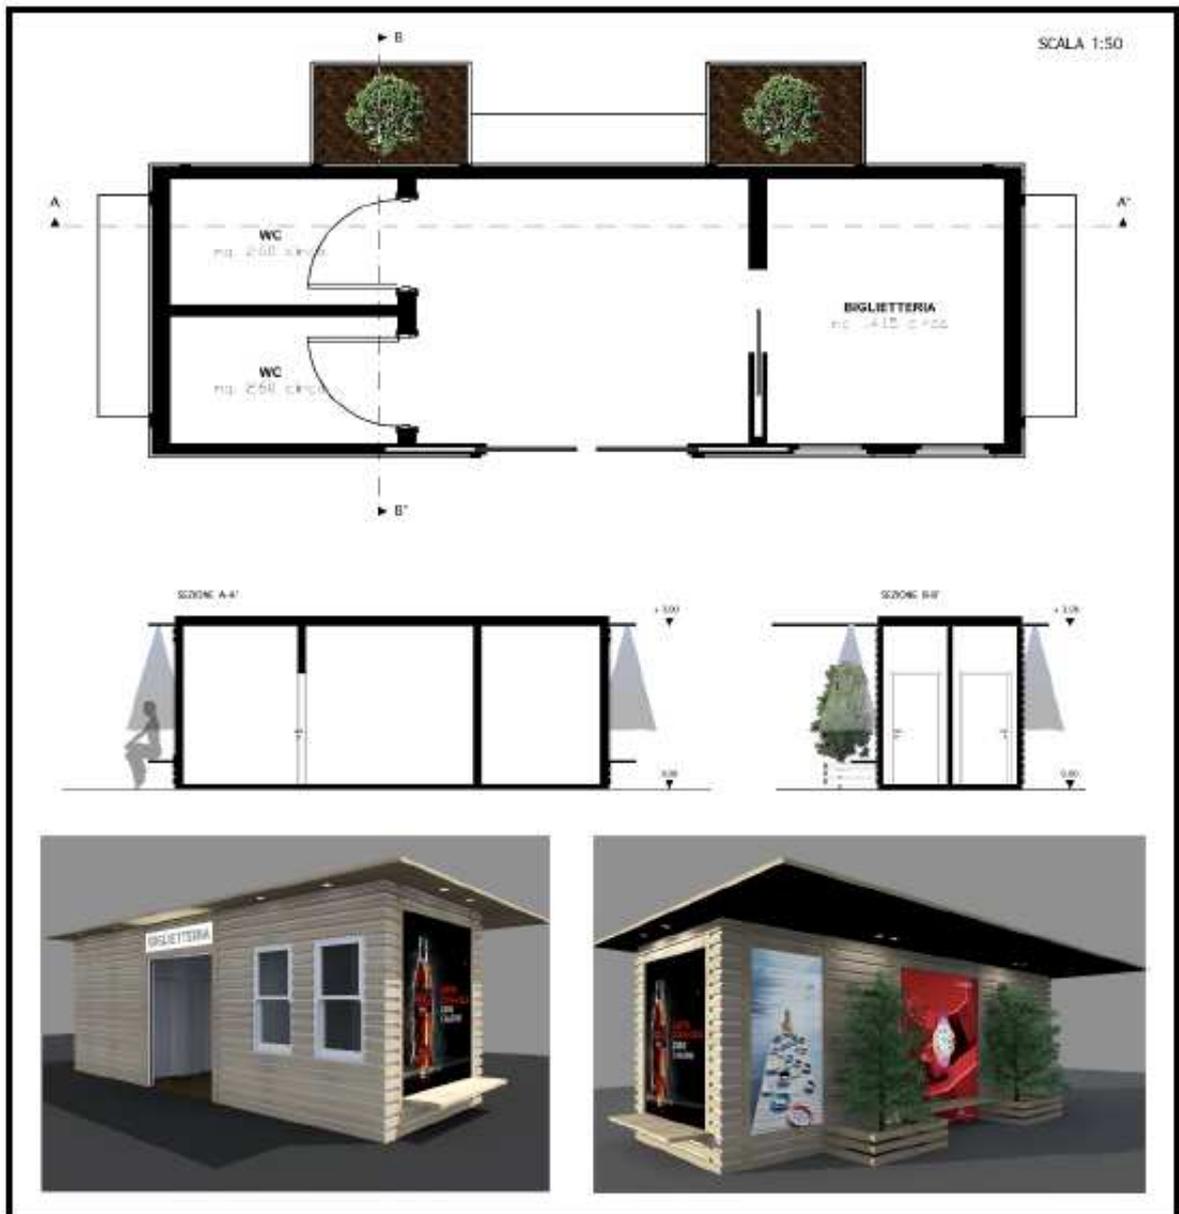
Tipologia di struttura metallica modulare adottata nel progetto
